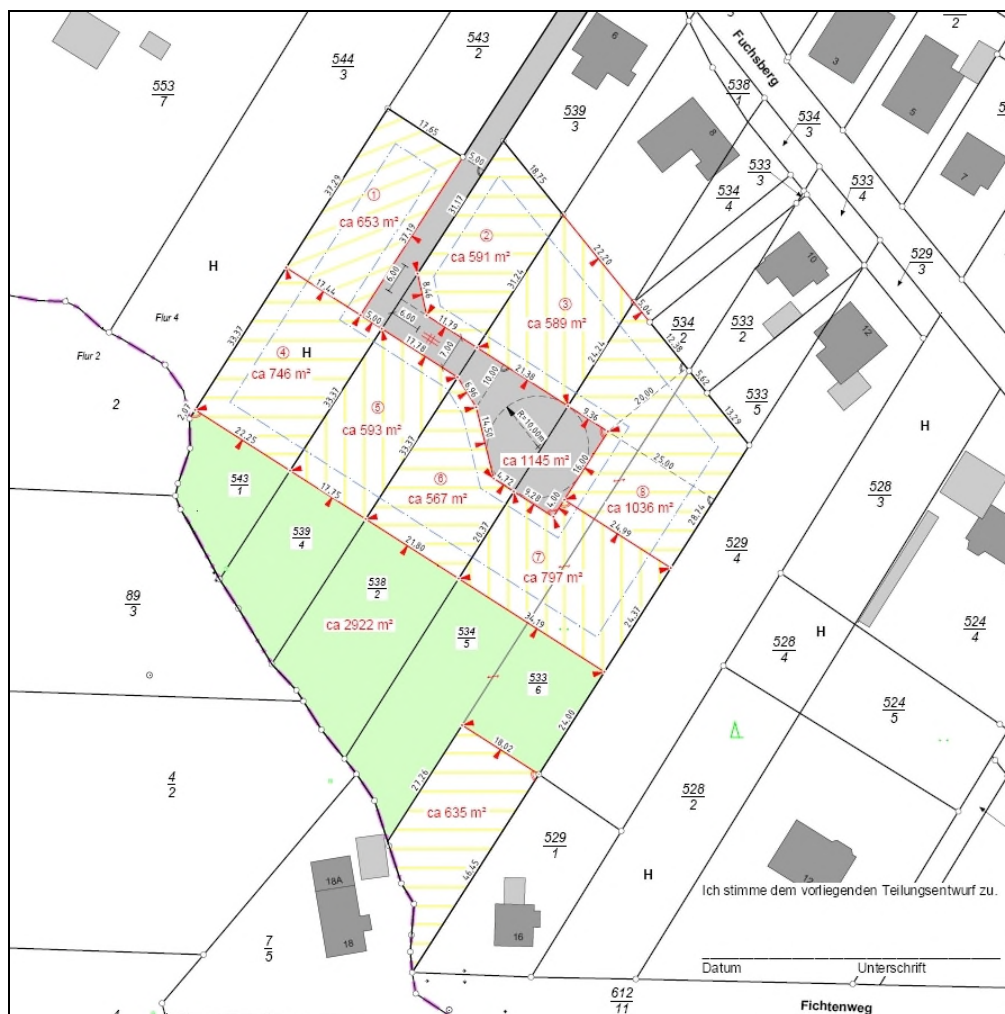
Plangebiet (farbig dargestellte Flächen – Darstellung: RMK).
